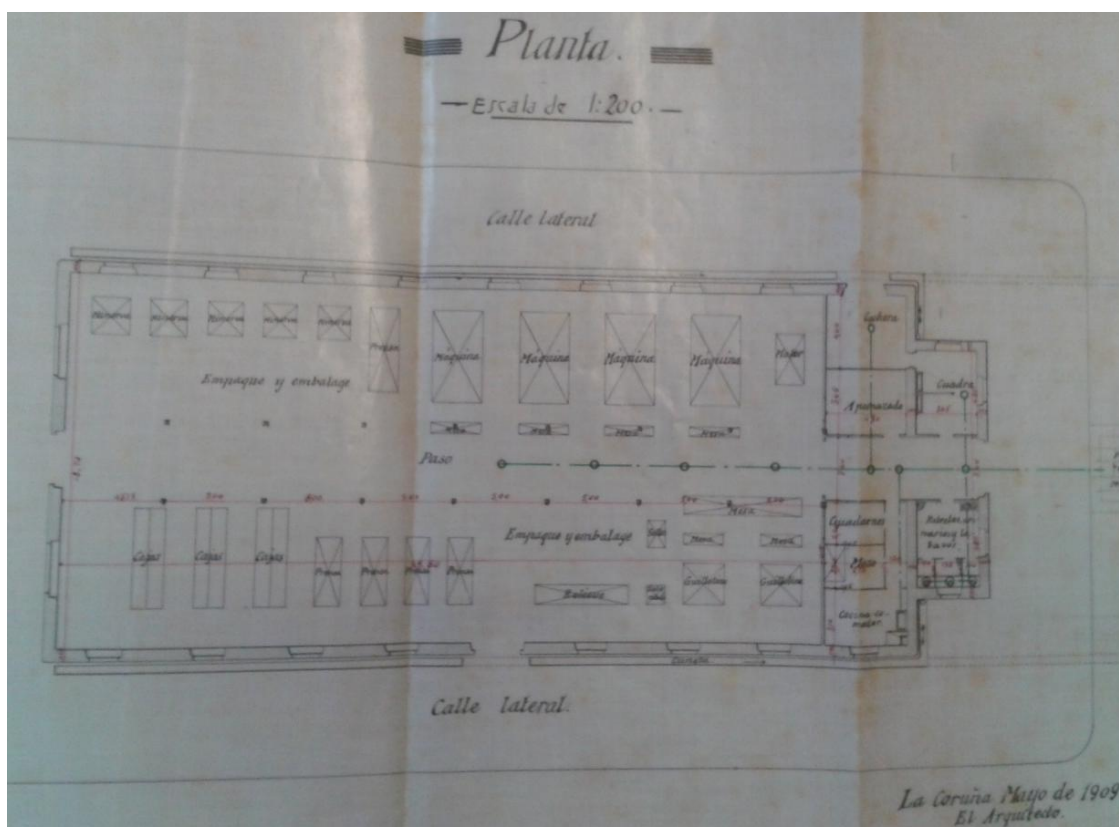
Planta de la Imprenta Roel, 1909 (FUENTE: AHMC).
